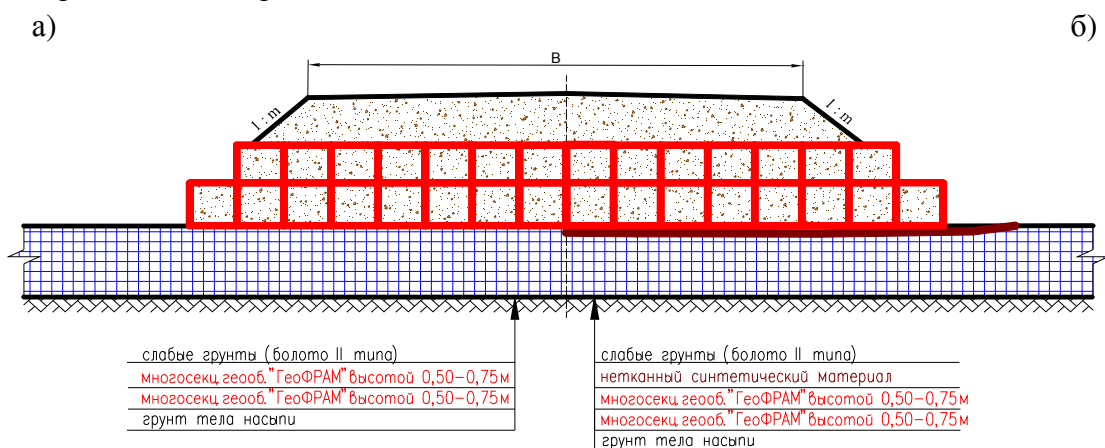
Конструкция насыпи высотой более 1,50 м на слабом основании II-го типа
